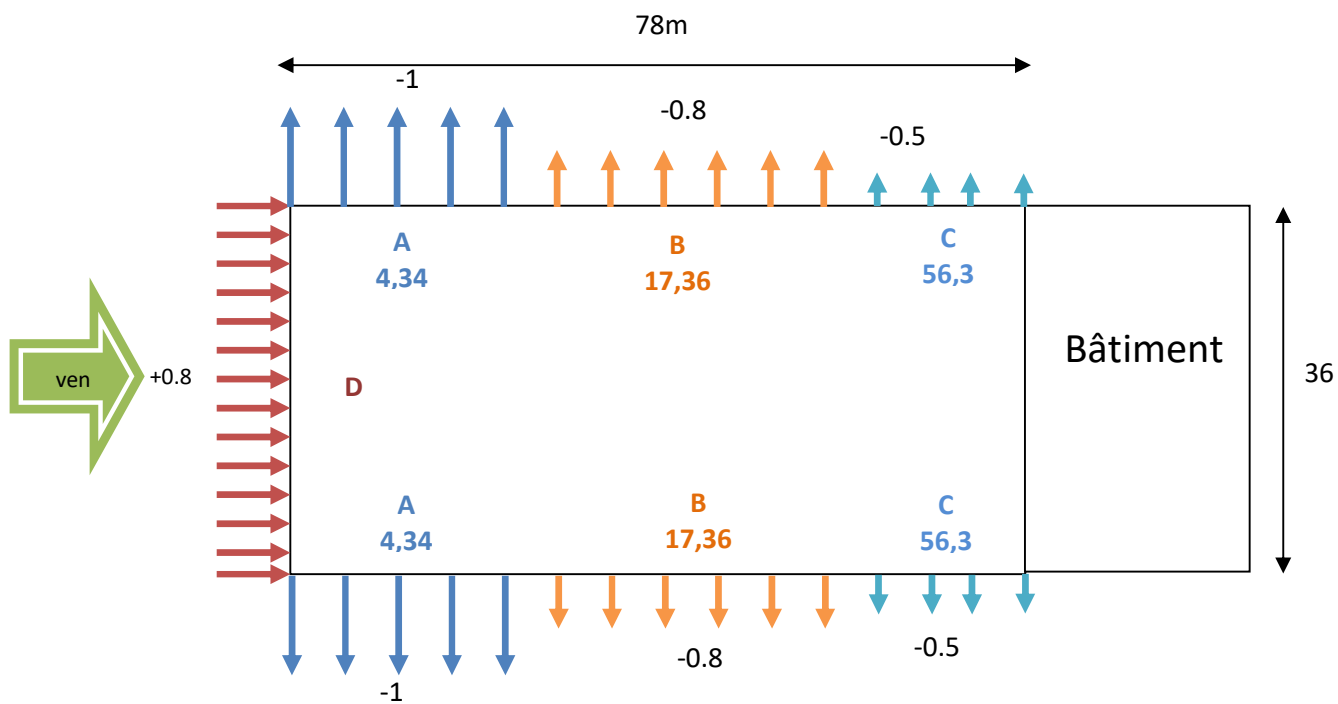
Cpe pour parois verticales (Vent sur pignon).
